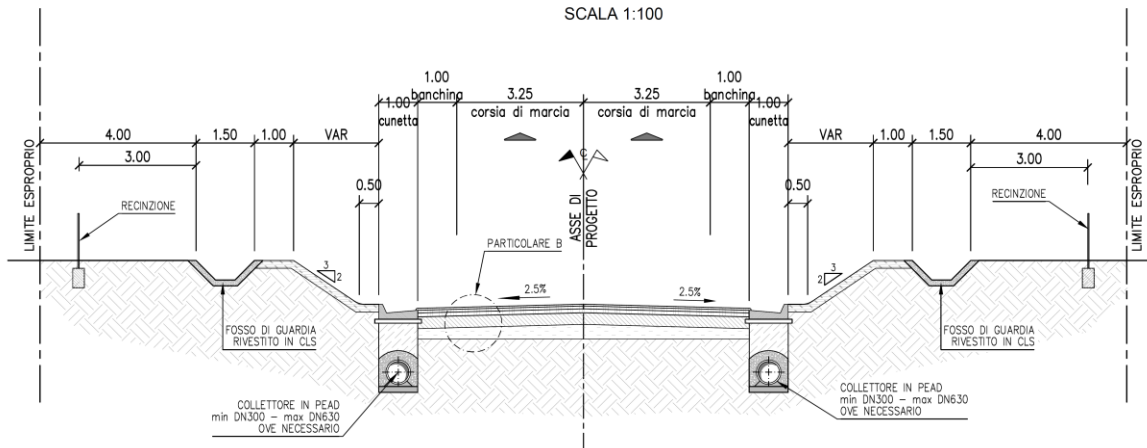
Sezione tipo in scavo asse secondario – Strada di Accesso alla Dorsale Consortile CASIC
